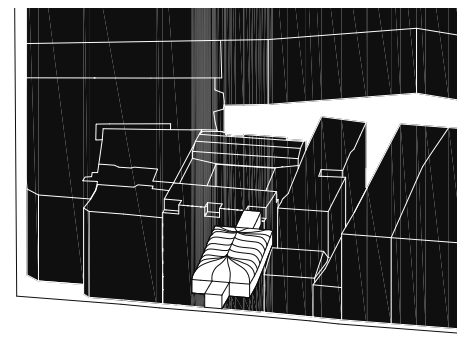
Pasáž paláce Sušický 1:2000.
